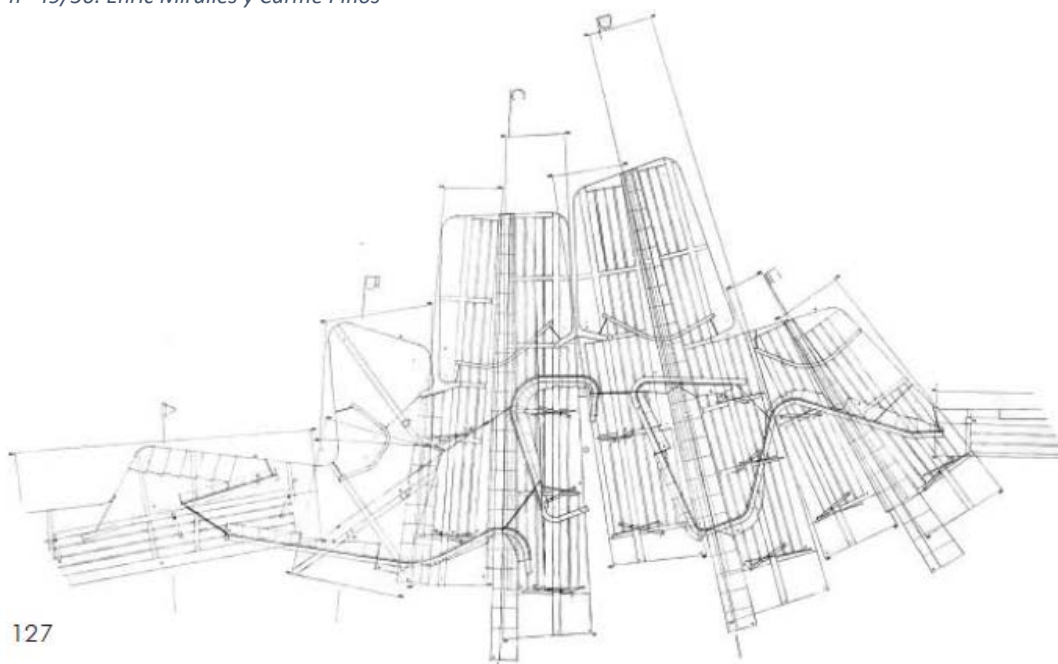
Planta general de las Instalaciones de Tiro con Arco para los JJOO de Barcelona 92. El Croquis nº 49/50. Enric Miralles y Carme Pinós
